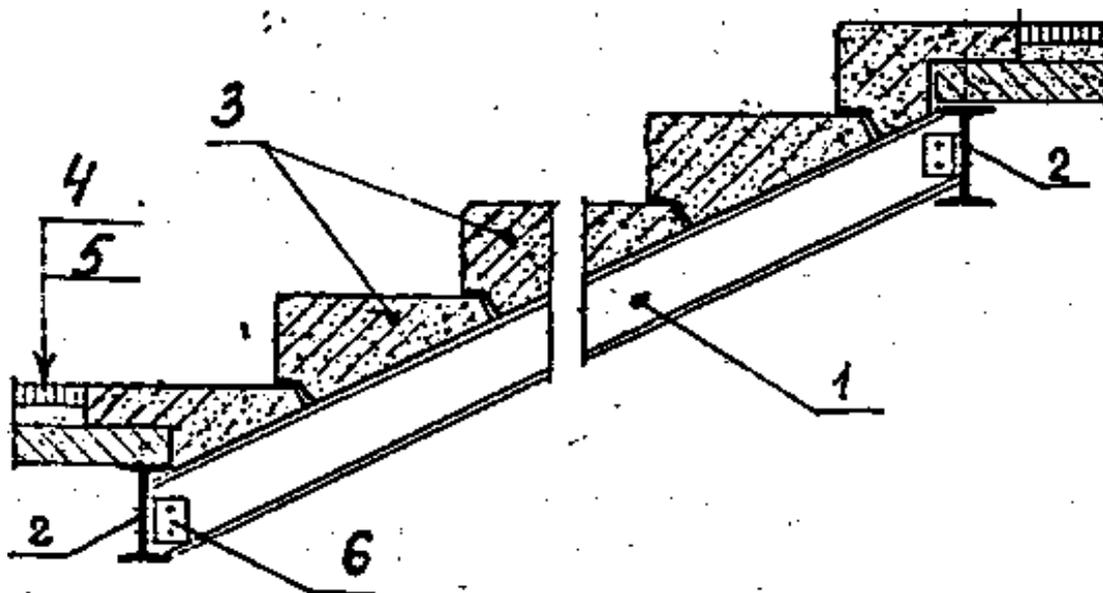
Конструкція сходів по сталевих косоурах: 1 - сталевий косоур - двотавр № 16; 2 - поперечна балка - двотавр № 20; 3 - залізобетонні сходинокки; 4 - керамічна плитка на розчині; 5 - залізобетонна плита площинки - 80; 6 - з'єднання кутиками.
